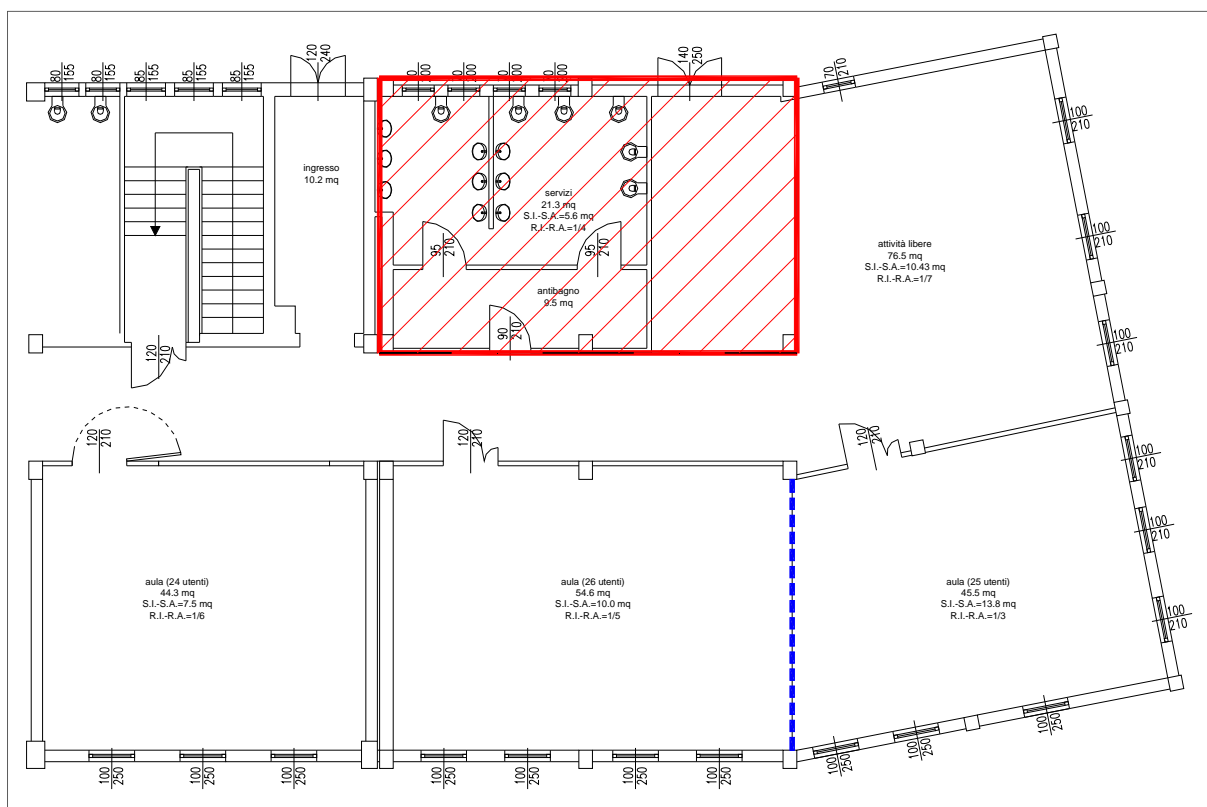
Scuola infanzia del capoluogo, pianta piano primo.
